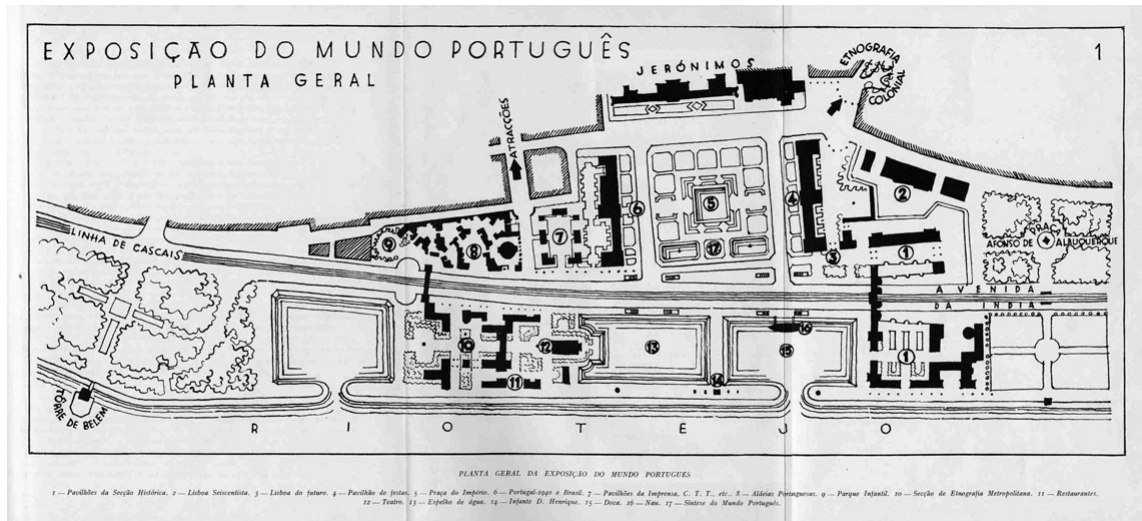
| 1ª PLANTA GERAL DA EXPOSIÇÃO.
